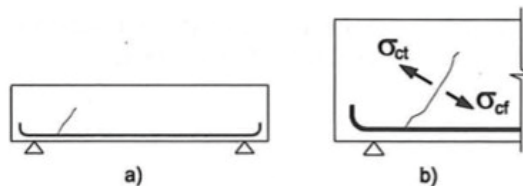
Fisuras por tensiones de tracción en el hormigón (Fuente: Calavera, 2005)
